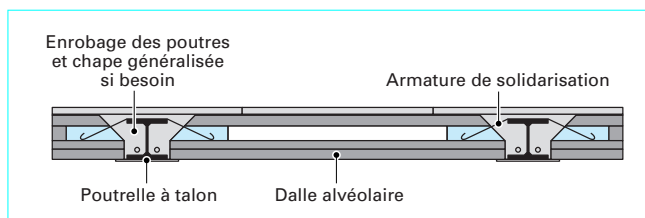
Planchers mixtes acier-béton à poutrelles intégrées
